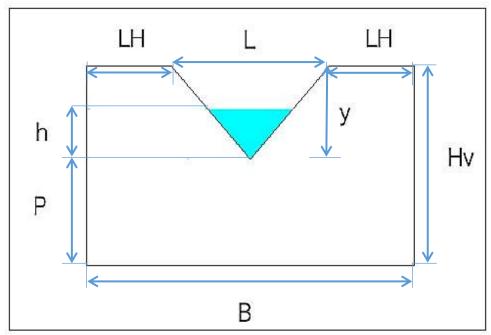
Esquema de construcción del vertedor. FUENTE: Memoria de cálculo PTAR, San Isidro.
